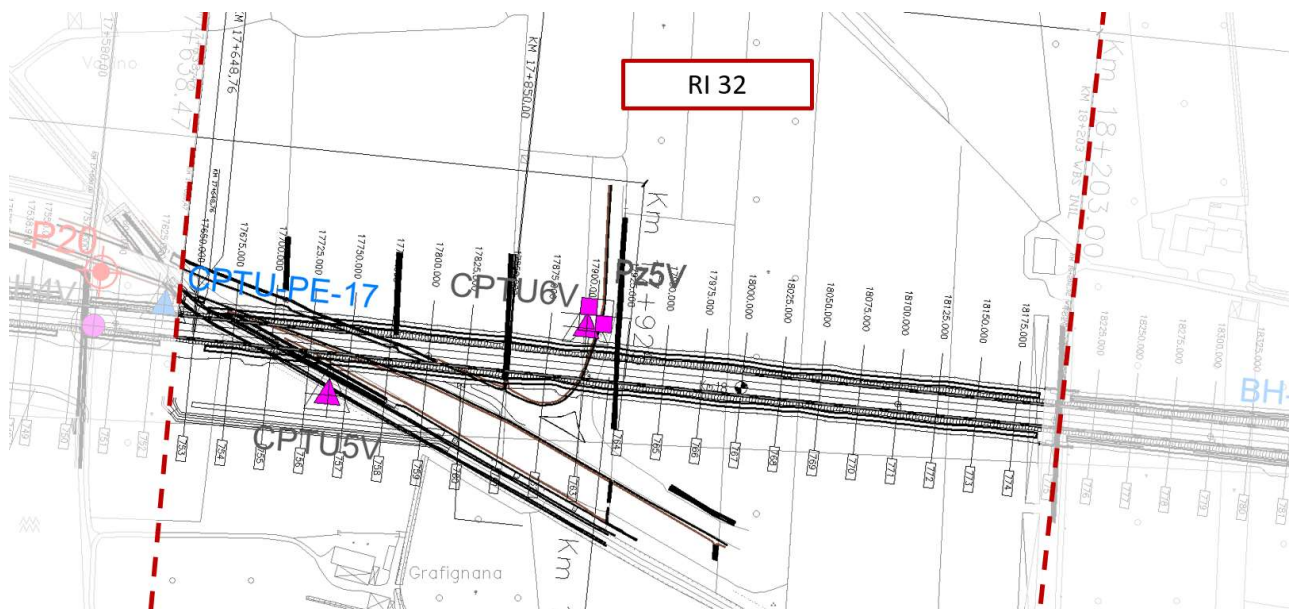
Planimetria Rilevato RI32, estratto dalla Planimetria Generale (Doc. Rif. [3])
